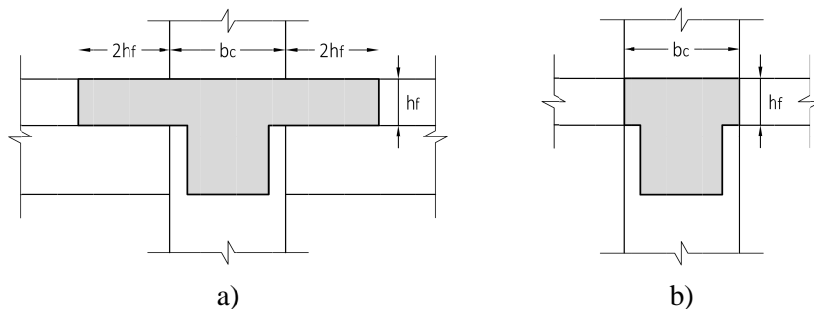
Largura efetiva do banzo de vigas ligadas a pilares exteriores
